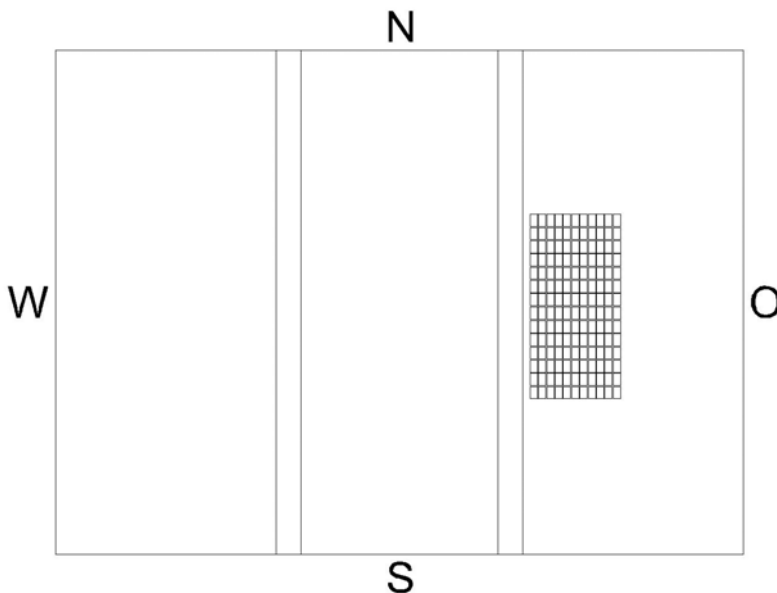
Künstliche Last auf dem Dach der Turnhalle, Lage der Belastungseinrichtung
